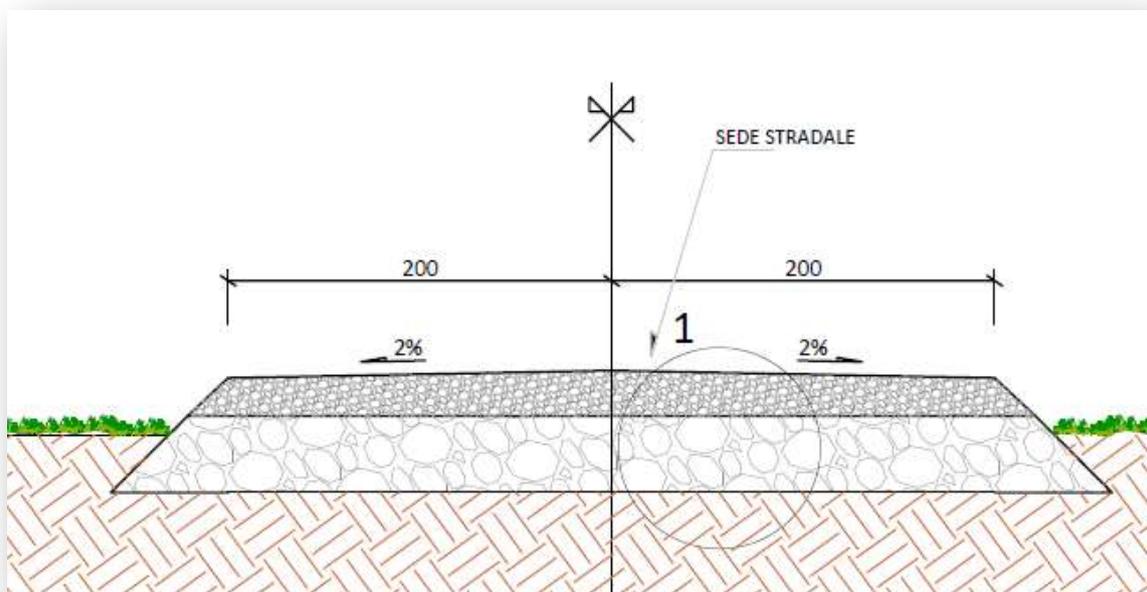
Estratto Elab. R.10 Planimetria viabilità interna parco
